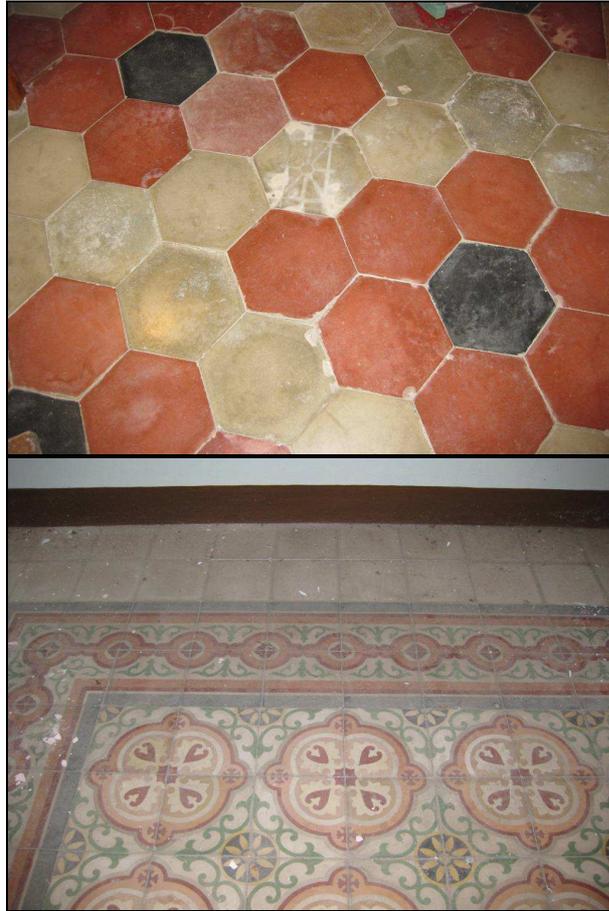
pavimentazioni con piastrelle in graniglia di cemento posate su letto di sabbia e calce.
